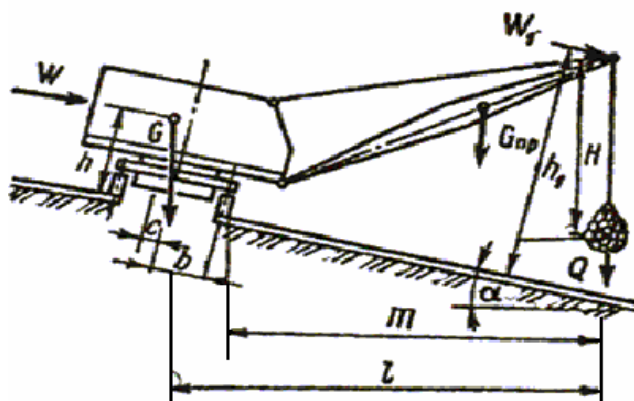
Расчетная схема устойчивости самоходного крана с грузом
